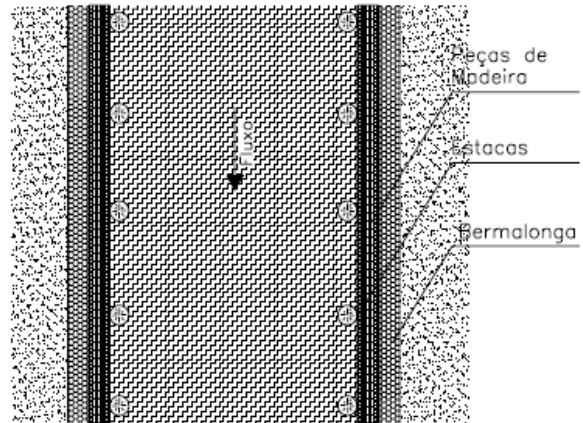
Vista em planta (PEREIRA; PEREIRA, 2009b).
